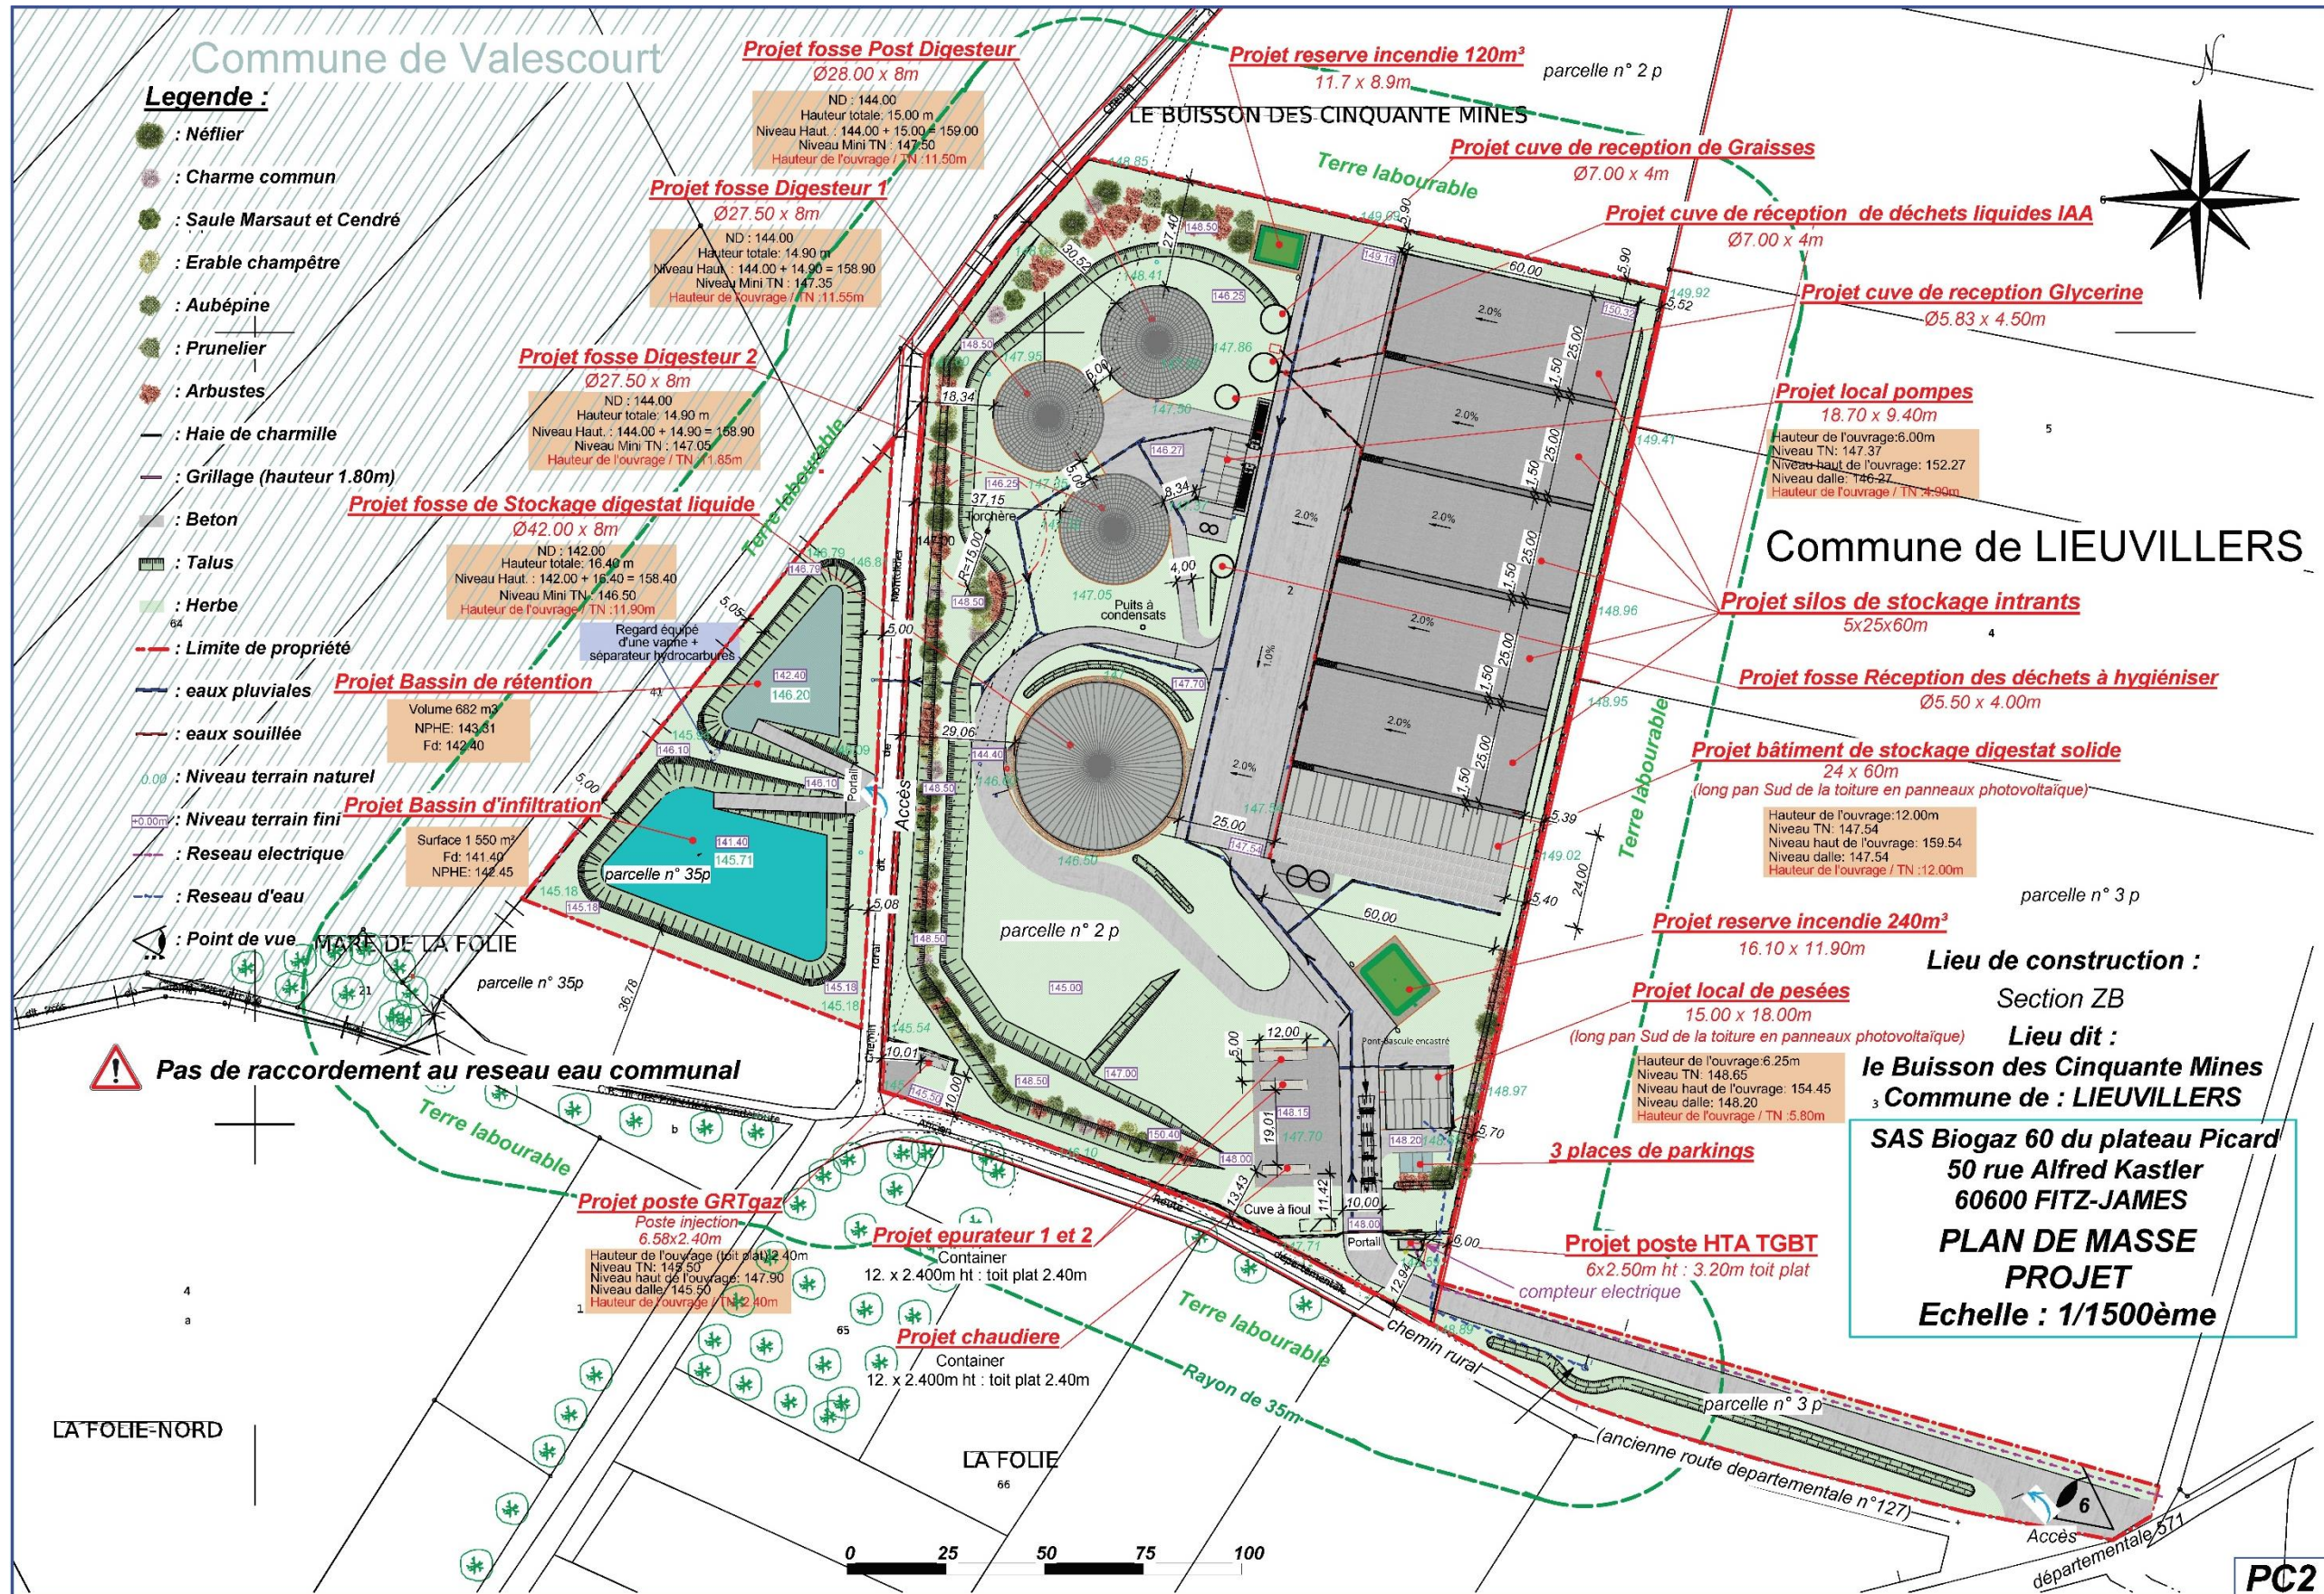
Plan de masse de l'installation (source : AC'Energy Green, 2021)
